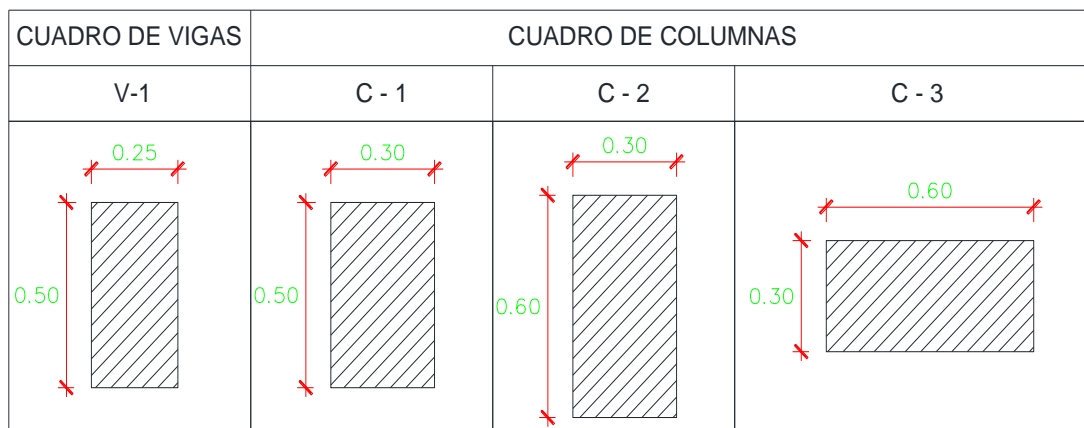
Secciones de vigas y columnas usadas para el modelado estructural.
